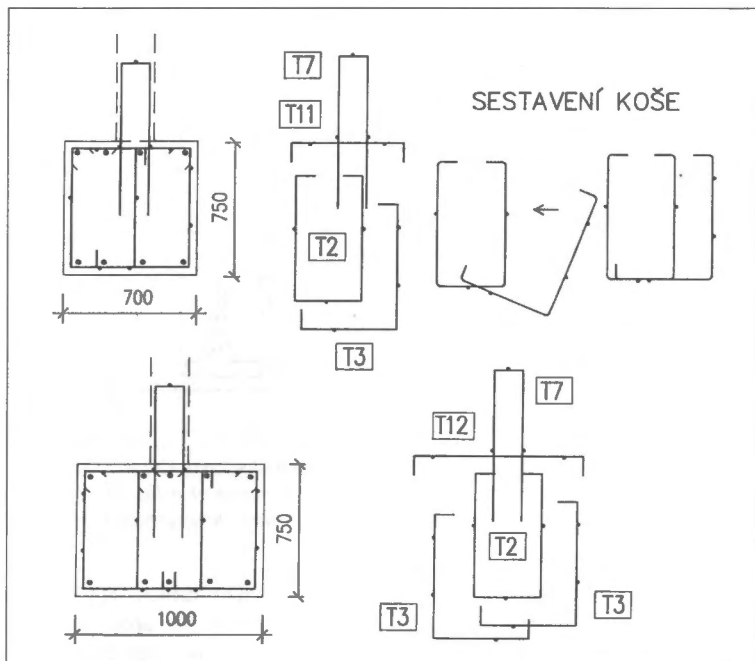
Zesílení smyčkové výztuže zdvojením stejných třmínkových prvků / Strengthening of the shear reinforcement by duplication of stirrup elements
